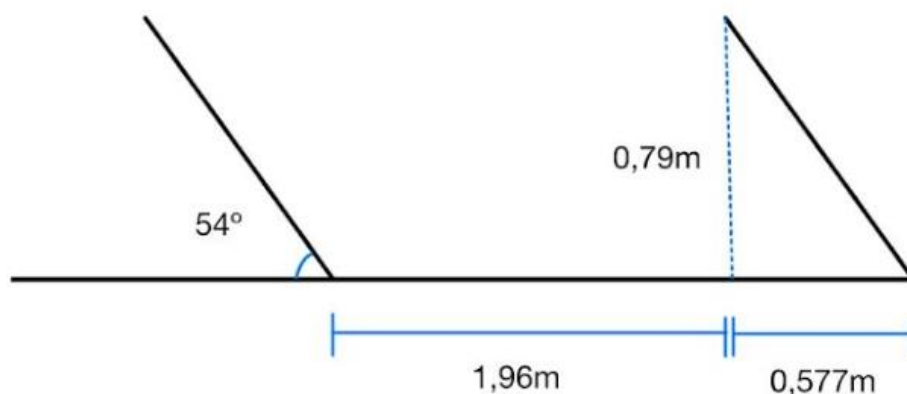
Esquema detalle de la separación entre placas, visión de perfil. Fuente: Elaboración propia
